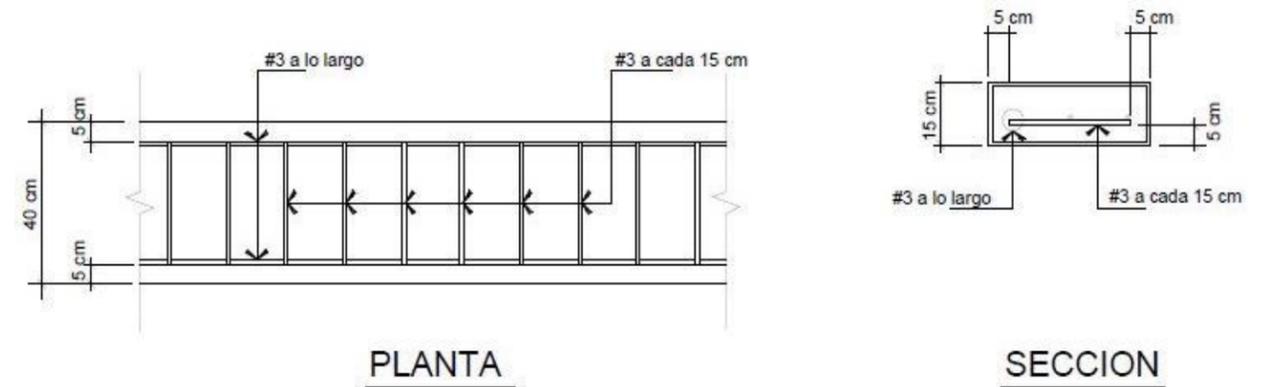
Detalles en sección y planta de zapata aislada. Fuente: equipo de trabajo
